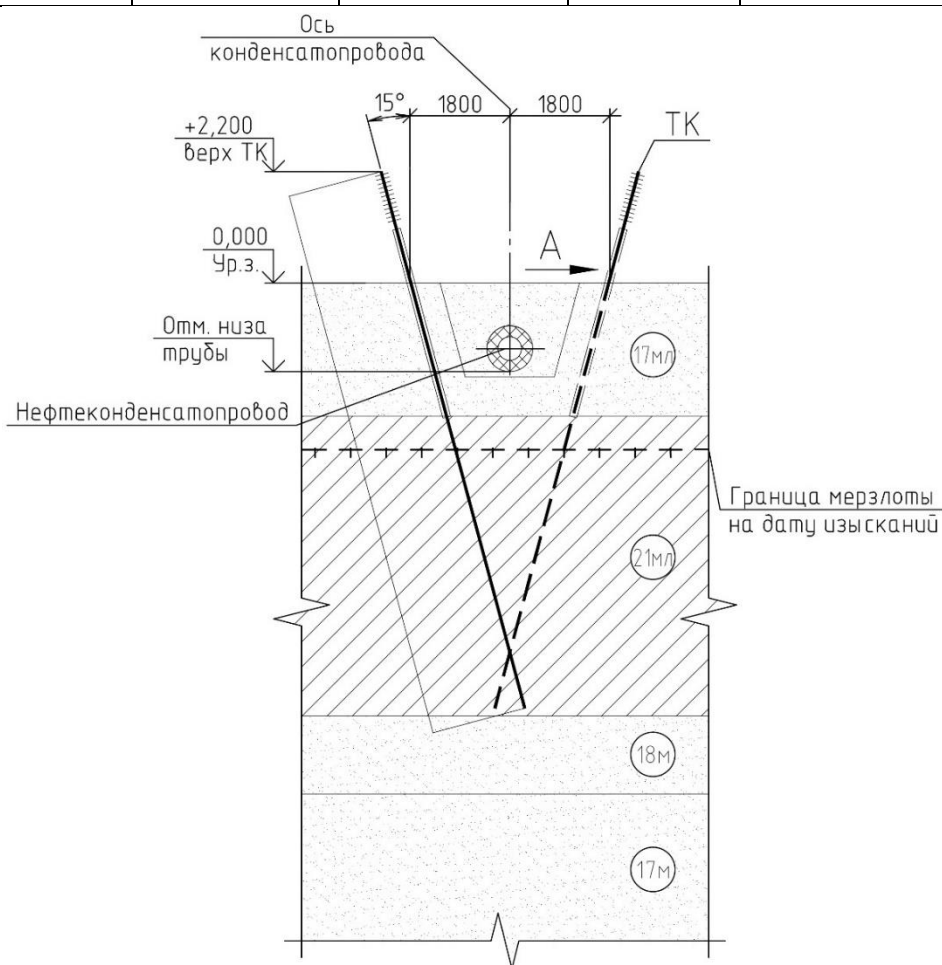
Схема установки СОУ в зоне укладки трубопровода
